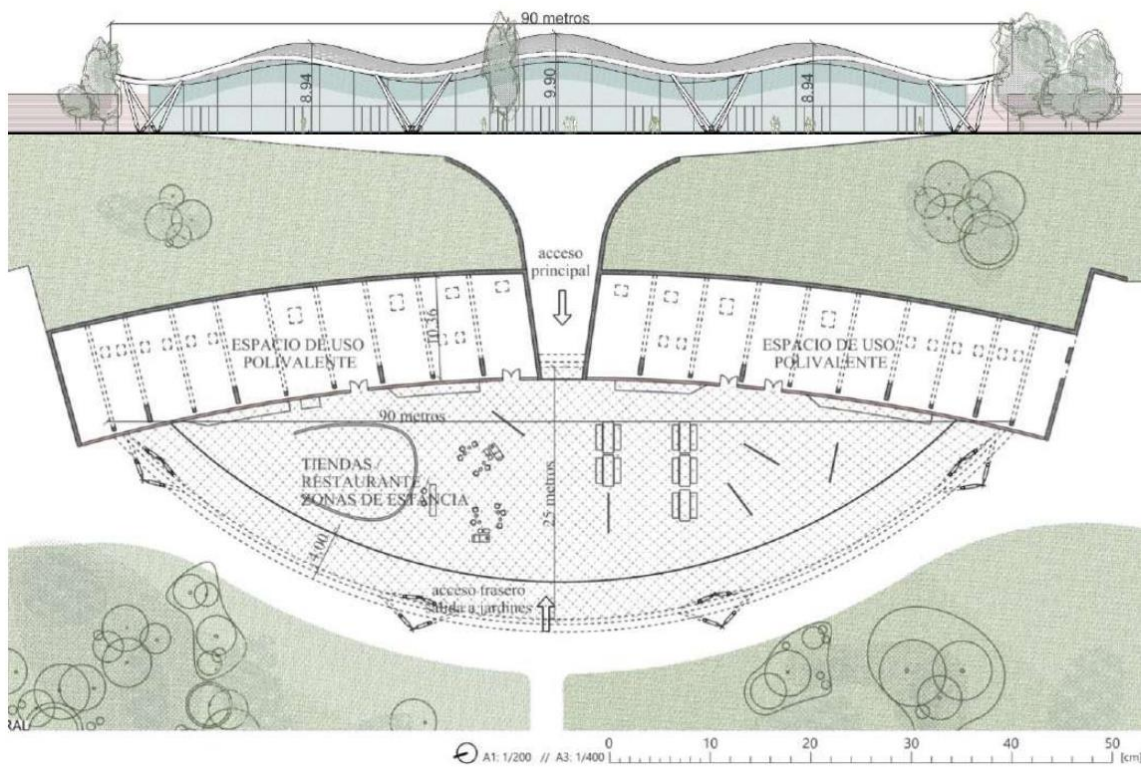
Planimetría – centro de visitantes de Savill Garden – Luis Lozano.
